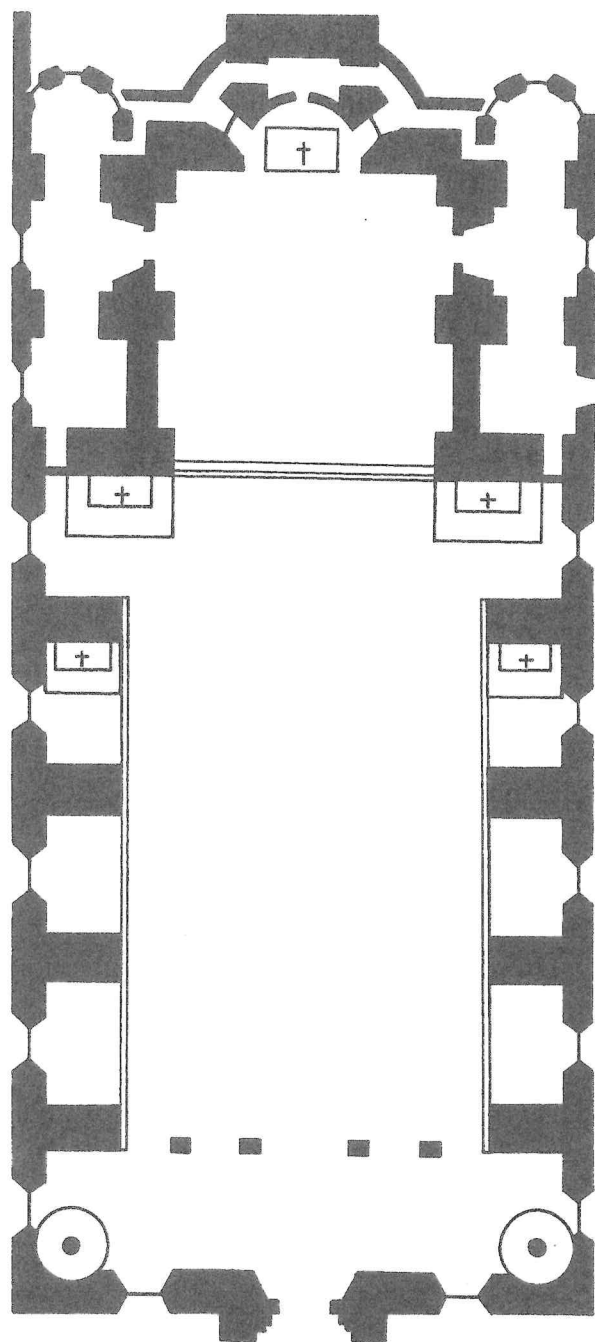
Innsbruck, Grundriß des ersten Neubaus der Jesuitenkirche (1619). Nach dem Originalplan (Kollegsarchiv S. J., Innsbruck, IX)
